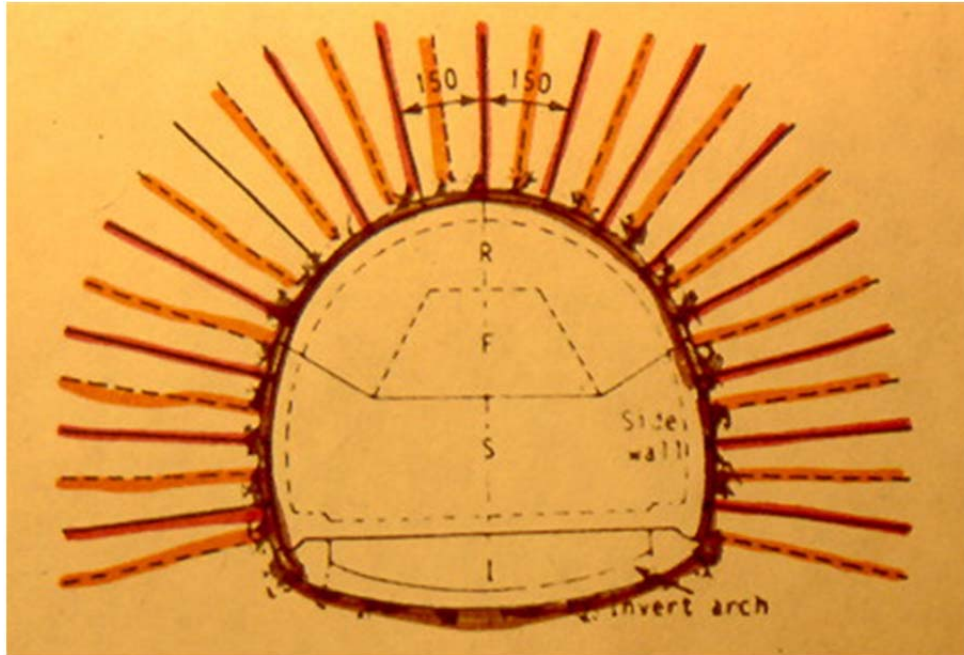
Estabilizado de las paredes del túnel por medio de concreto lanzado y anclas.
